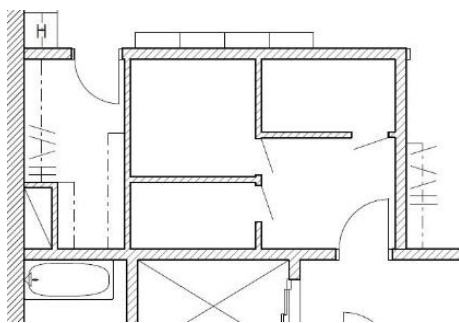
Planritning, byggnad 2, plan 2. Producerad i Revit.
